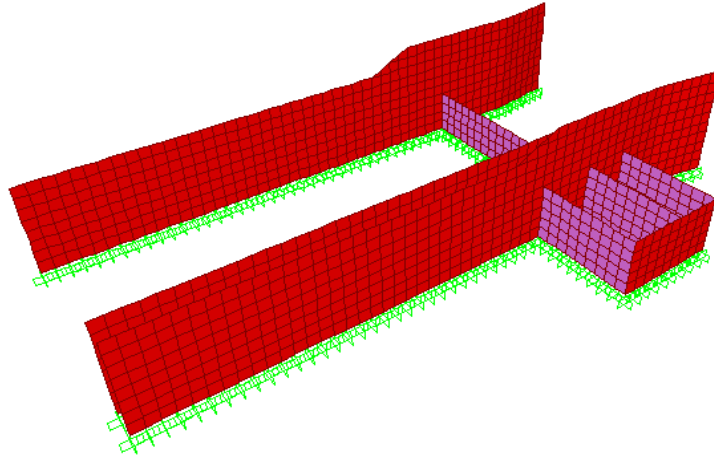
Modelamiento estructural de la captación en SAP 2000
